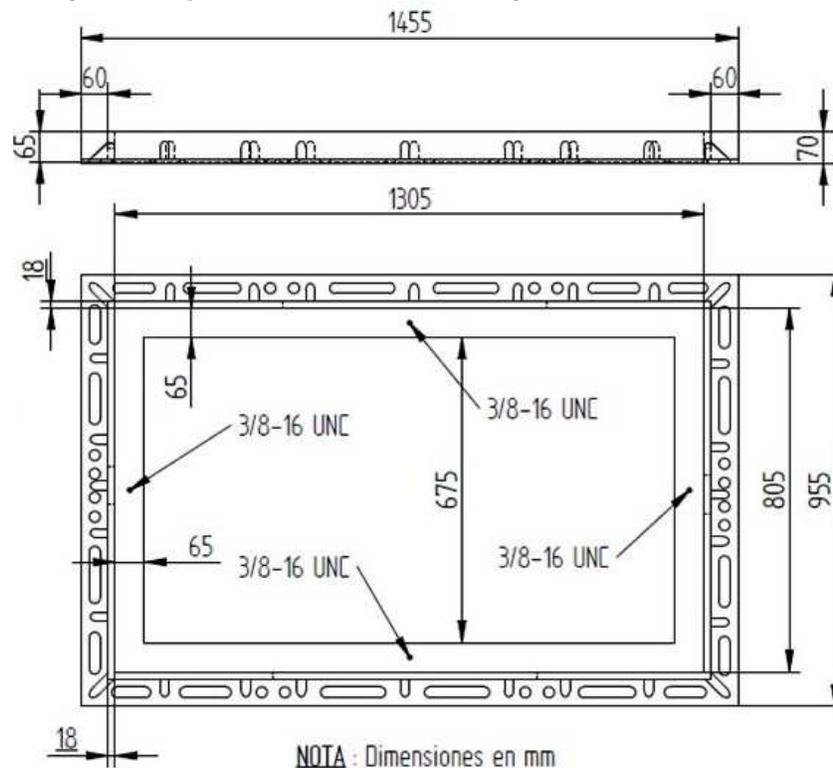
Marco para caja de inspección sencilla de MT y BT
